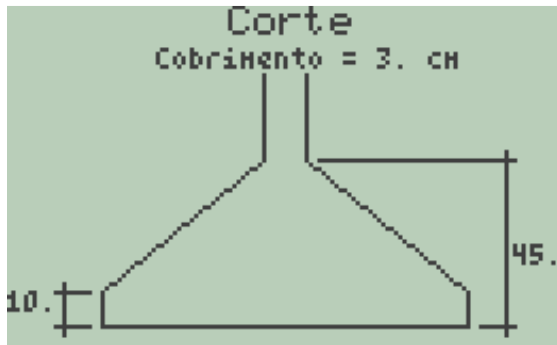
Sapata isolada - Detalhe da sapata - Corte.
